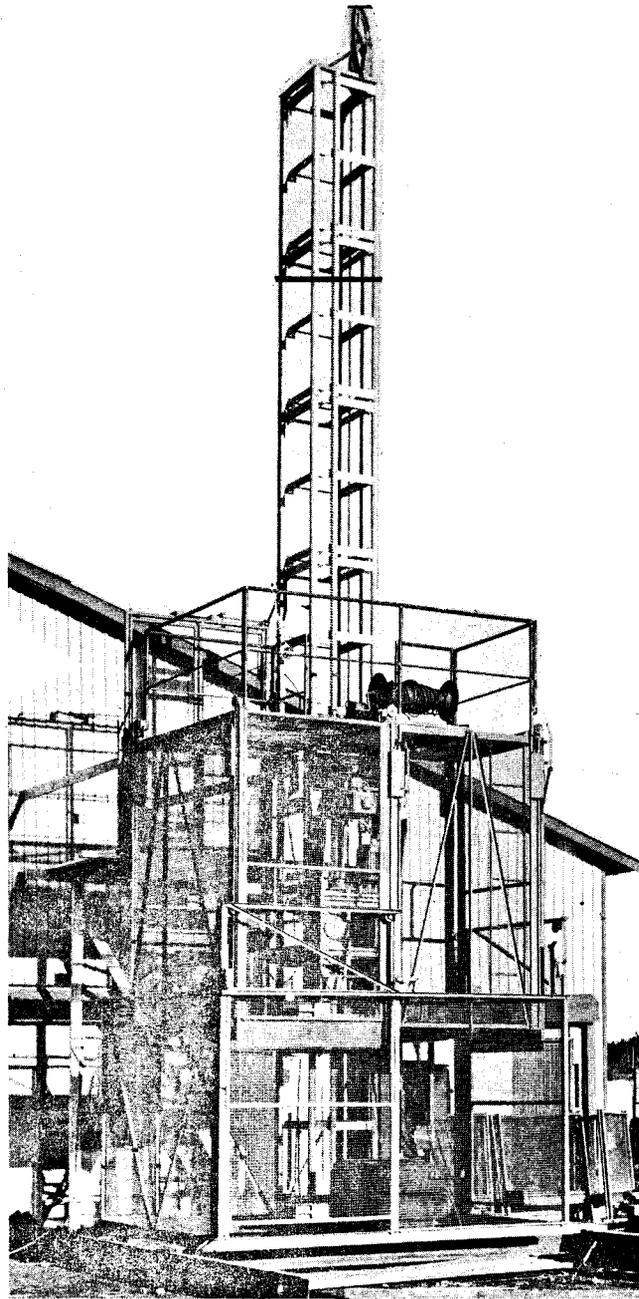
Las entradas a las cabinas o jaulas de los montacargas de trabajadores estarán provistas de puertas, compuertas o barreras en todos los lugares de acceso.
